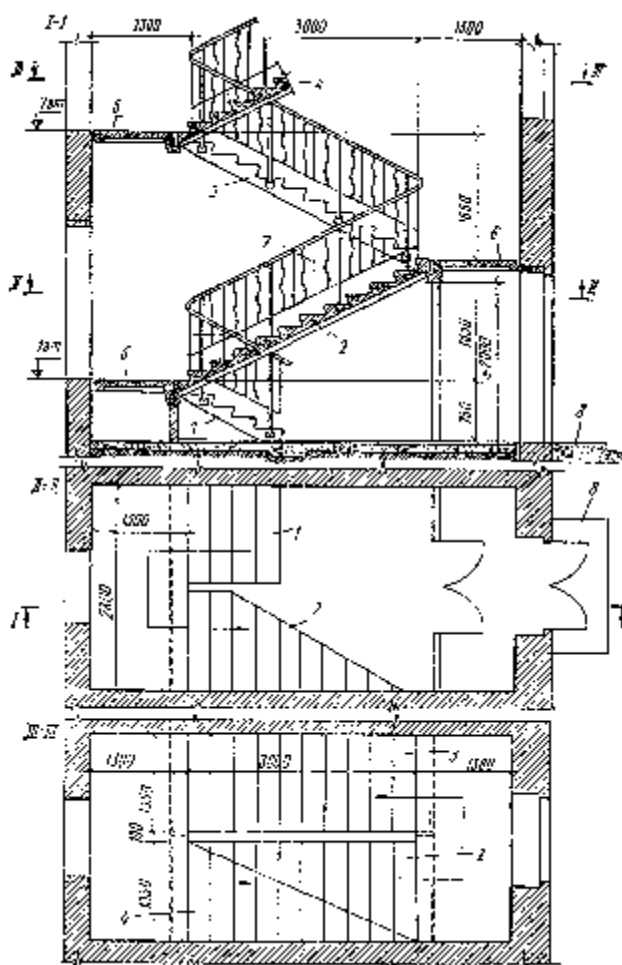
Поперечный разрез и поэтажные планы двухмаршевой лестницы из сборных железобетонных маршей и площадок при высоте этажа 3,3 м: 1 – цокольный марш; 2 – первый марш второго этажа; 3 – второй марш второго этажа; 4 – первый марш третьего этажа; 5, 6 – площадки; 7 – ограждение; 8 – входная площадка.
